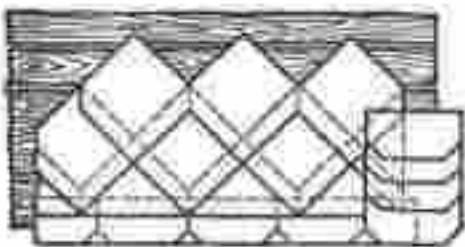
Кровельное покрытие из плоских асбестоцементных плиток.
